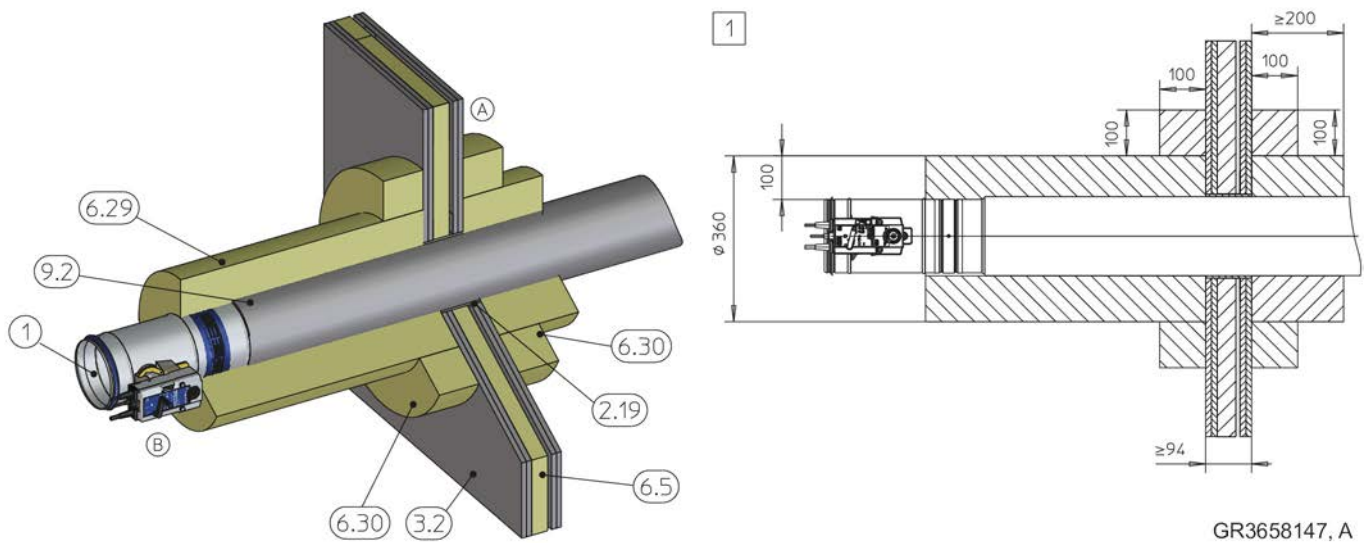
Монтаж на расстоянии от легких перегородок с заполнителем швов
